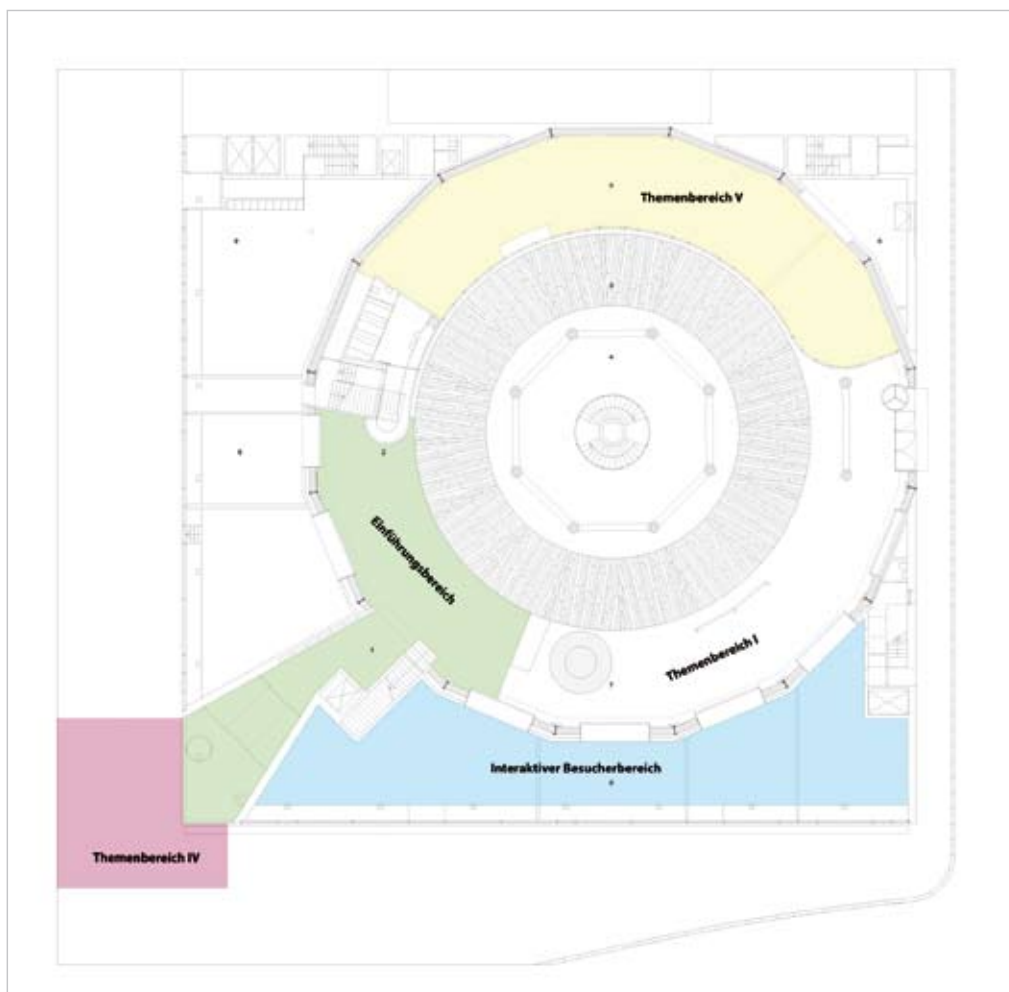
Bourbaki Panoramagebäude, Plan Parterre mit 5 Ausstellungsbereichen, 2014
